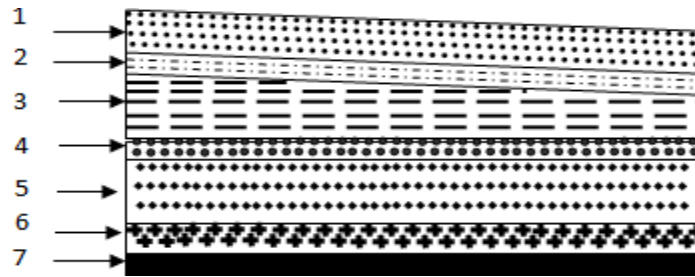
Plancher en corps creux de terrasse inaccessible
